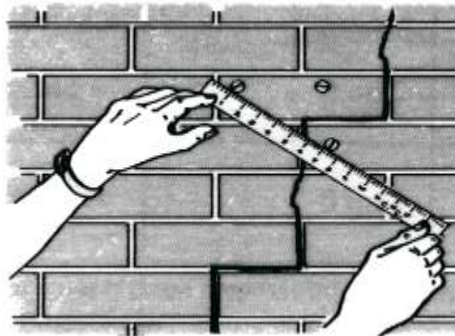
Mesure de fissure au niveau du poteau
